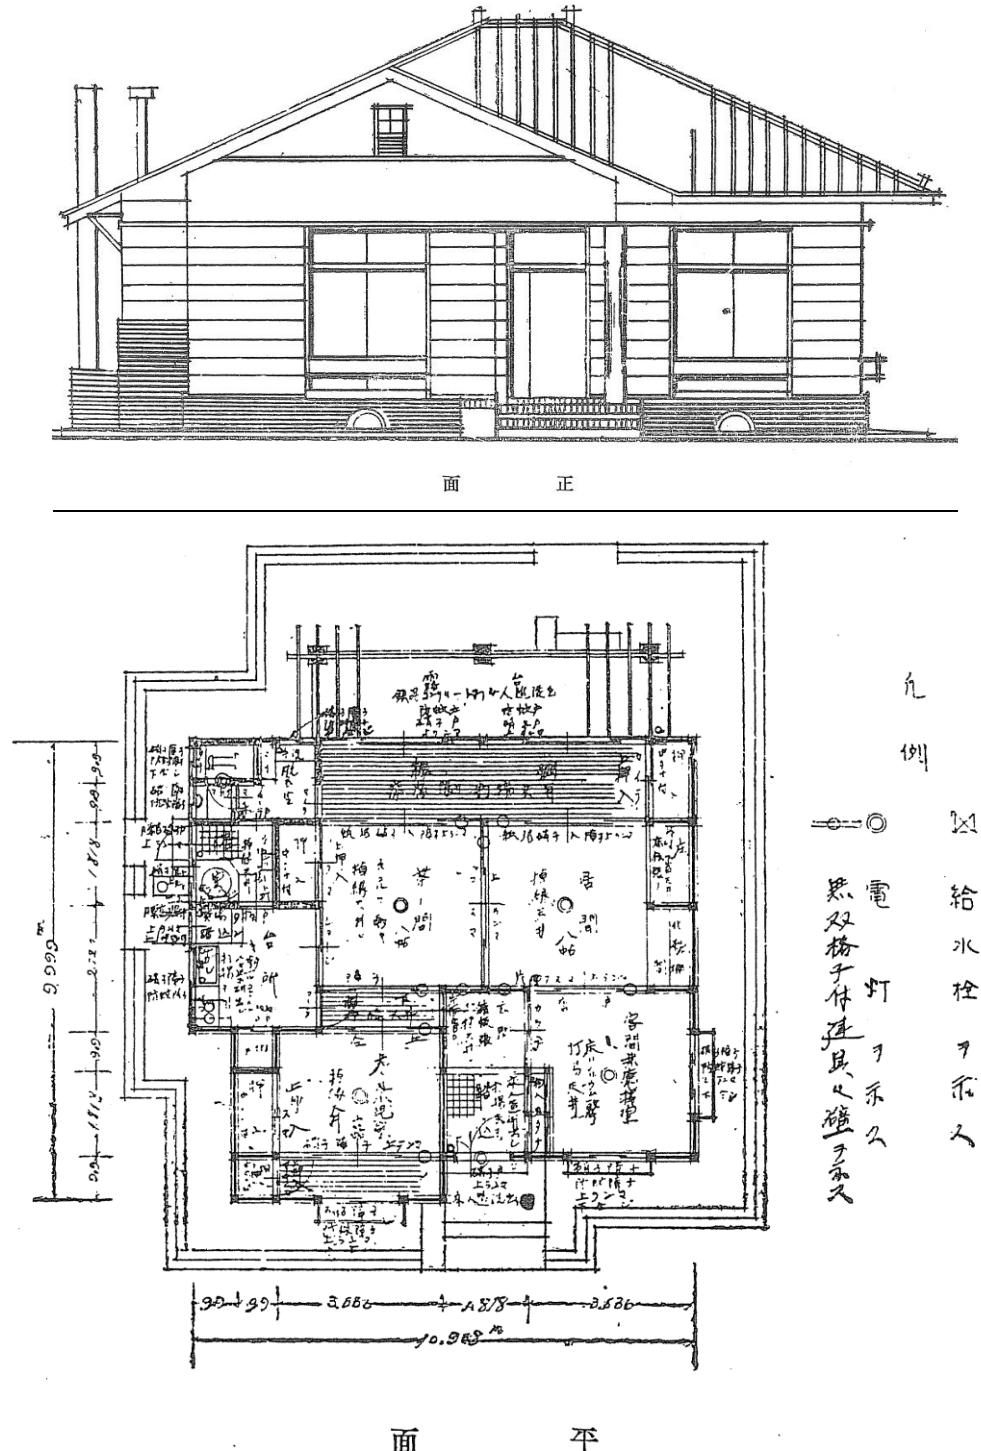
飛行第八聯隊奏任宿舍正面及平面圖
